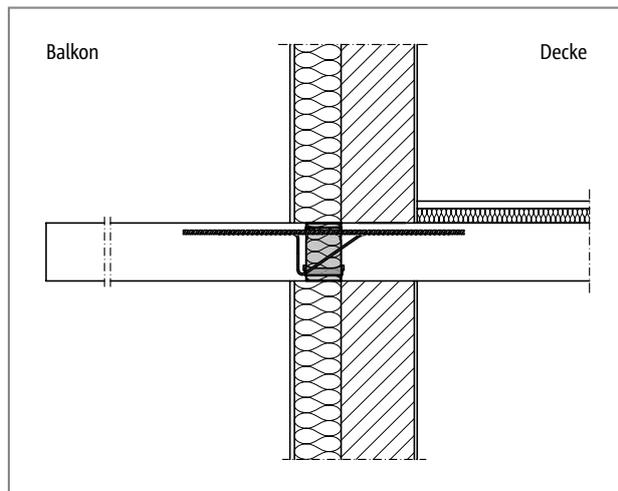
Darstellung einer Schnittzeichnung mit detailliertem Schöck Isokorb® Modell
